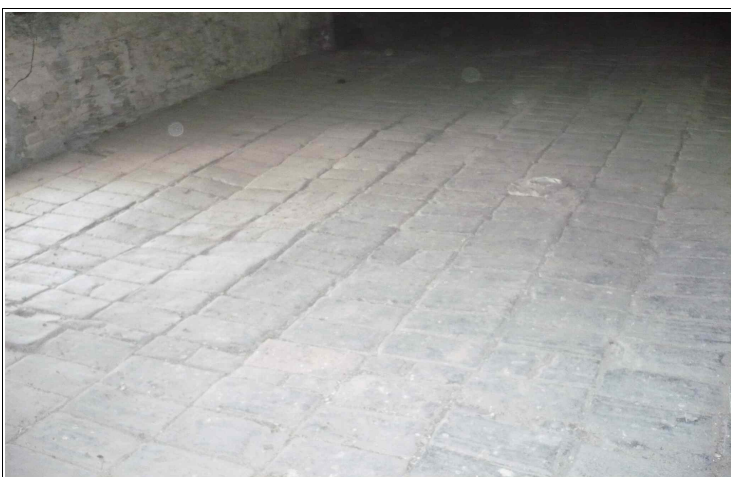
Esempio di deformazione del solaio in legno dell'ultimo piano sottotetto
